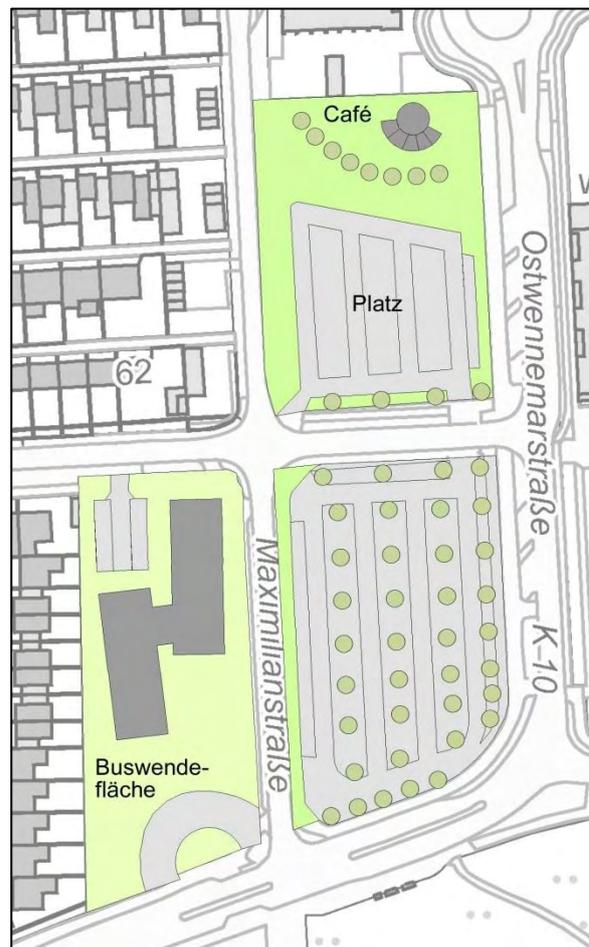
Entwurf Vorzugsvariante Zentrale Stellplatzanlagen
